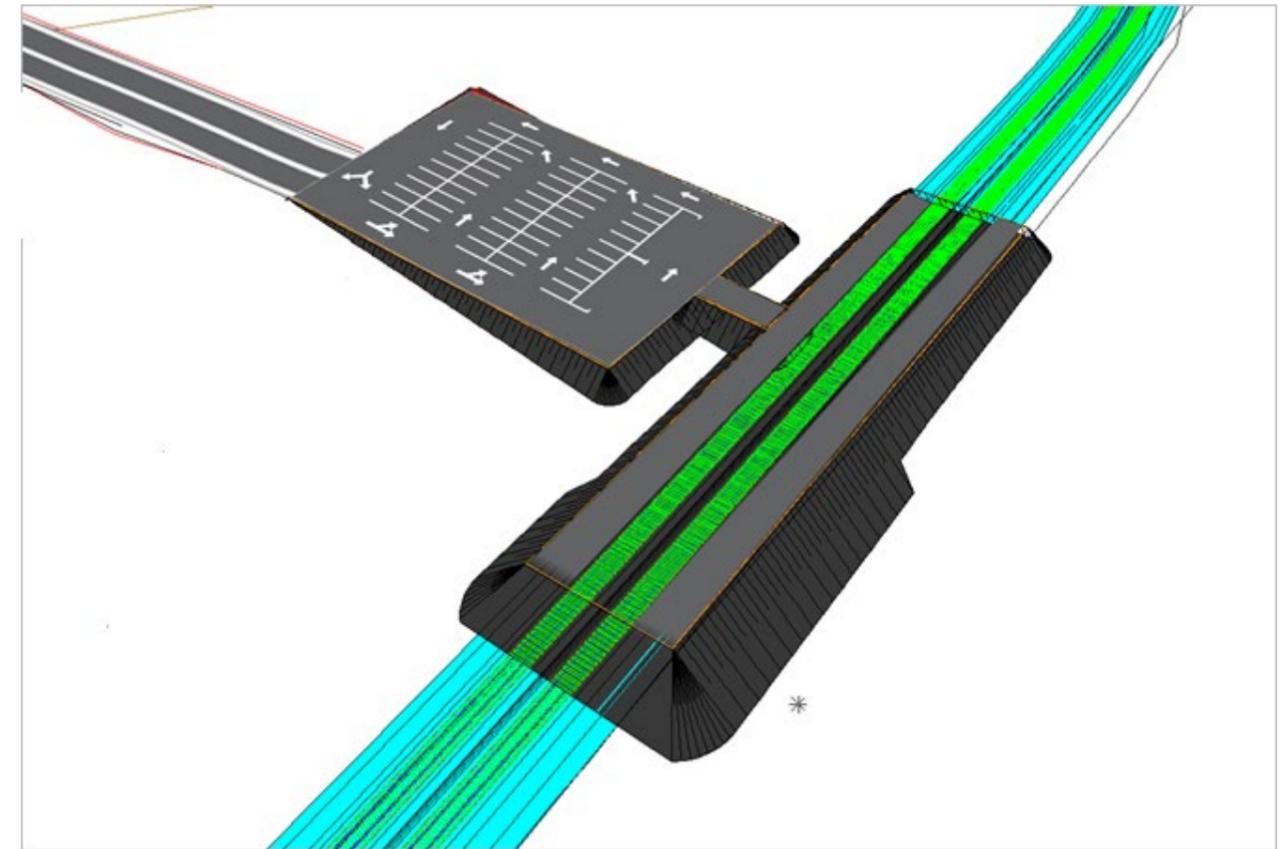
Vista 3D del apeadero, aparcamiento y camino de acceso de la alternativa 3A. Fuente: Istram
